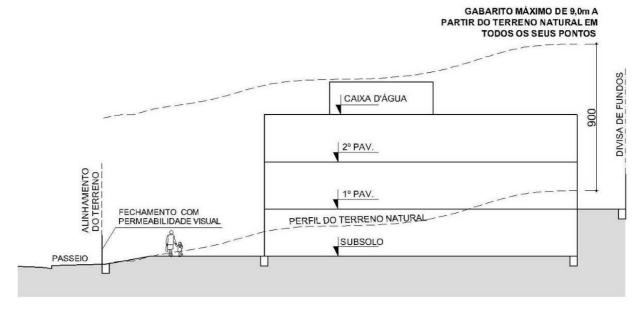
ADE Cidade Jardim - Terreno plano ou em aclive
